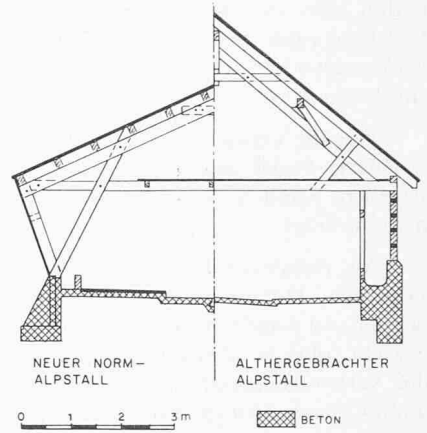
Vergleich der beiden Binderkonstruktionen, links Normstall, rechts alte traditionelle Bauweise
